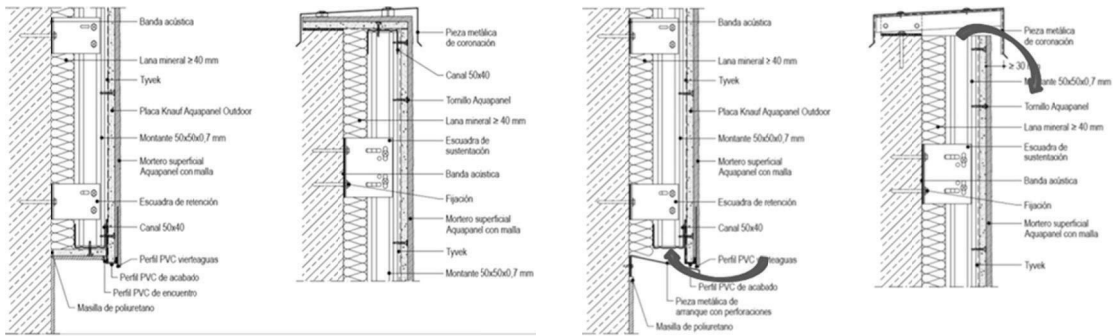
Sistema fachada Aquapanel ventilada y estanca. Imagen izquierda: Fachada Knauf Aquapanel sin ventilar. Imagen derecha: Fachada Knauf Aquapanel ventilada.
